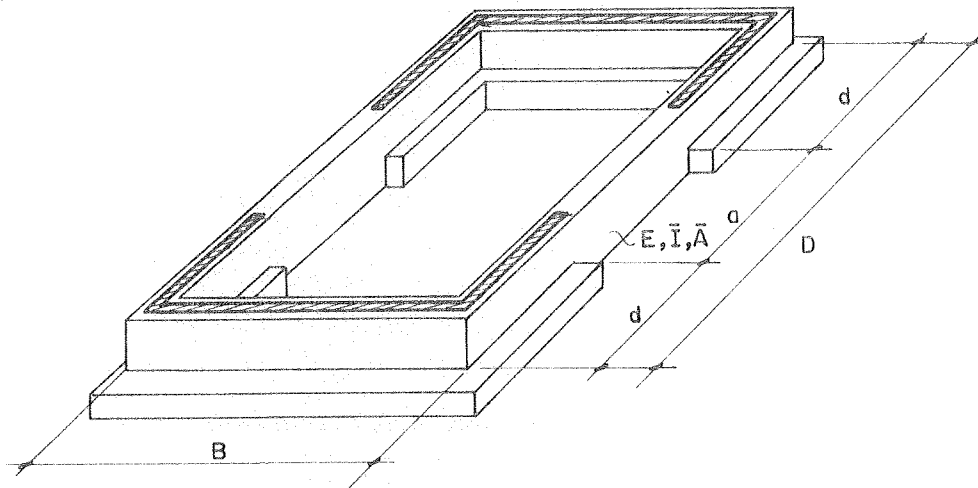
SAPATAS UNIDAS POR VIGAS DE RIGIDEZ.
